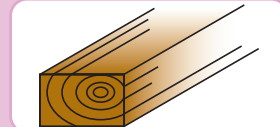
b. Viga de madera apoyada sobre el lado mayor de la sección
